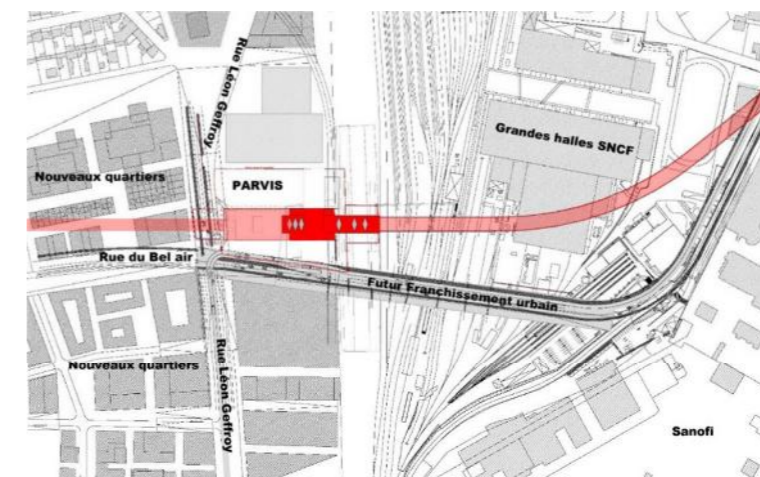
Plan de situation locale sans projet connexe (1/5000ème) – VPA 28/11/2014
